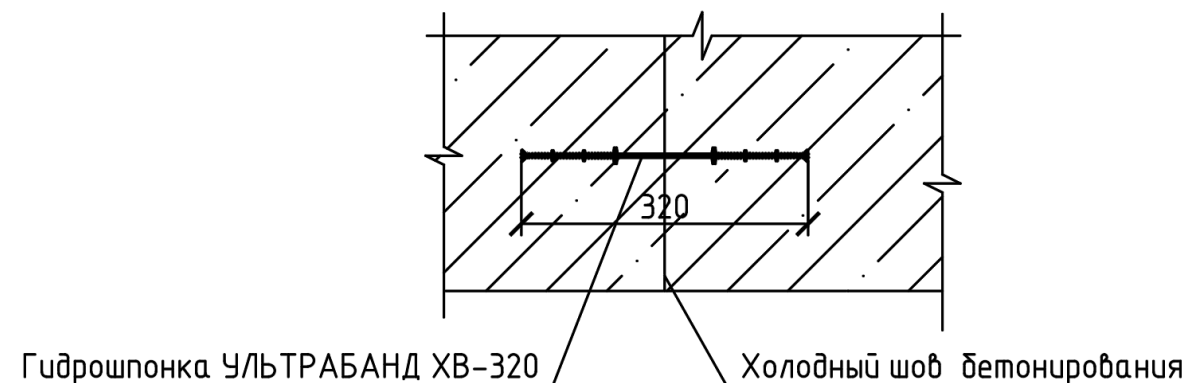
Герметизация рабочего шва бетонирования монолитной железобетонной фундаментной плиты с применением гидрошпонки УЛЬТРАБАНД ХВ-320
